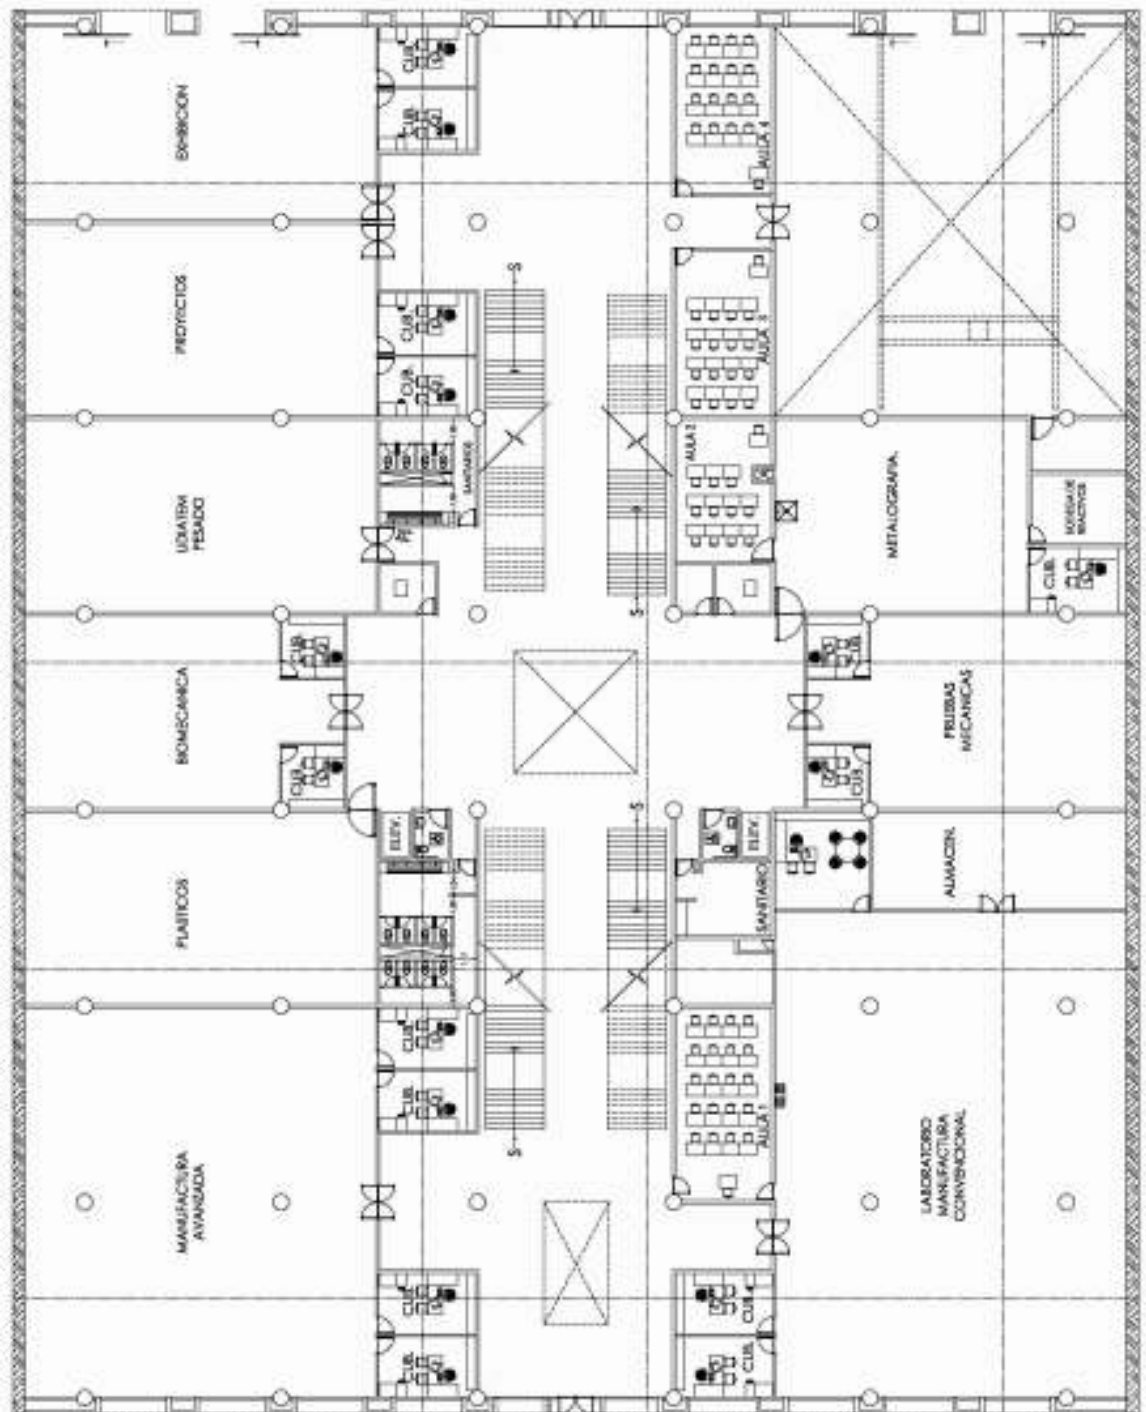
Planta Baja del Centro de Ingeniería Avanzada
